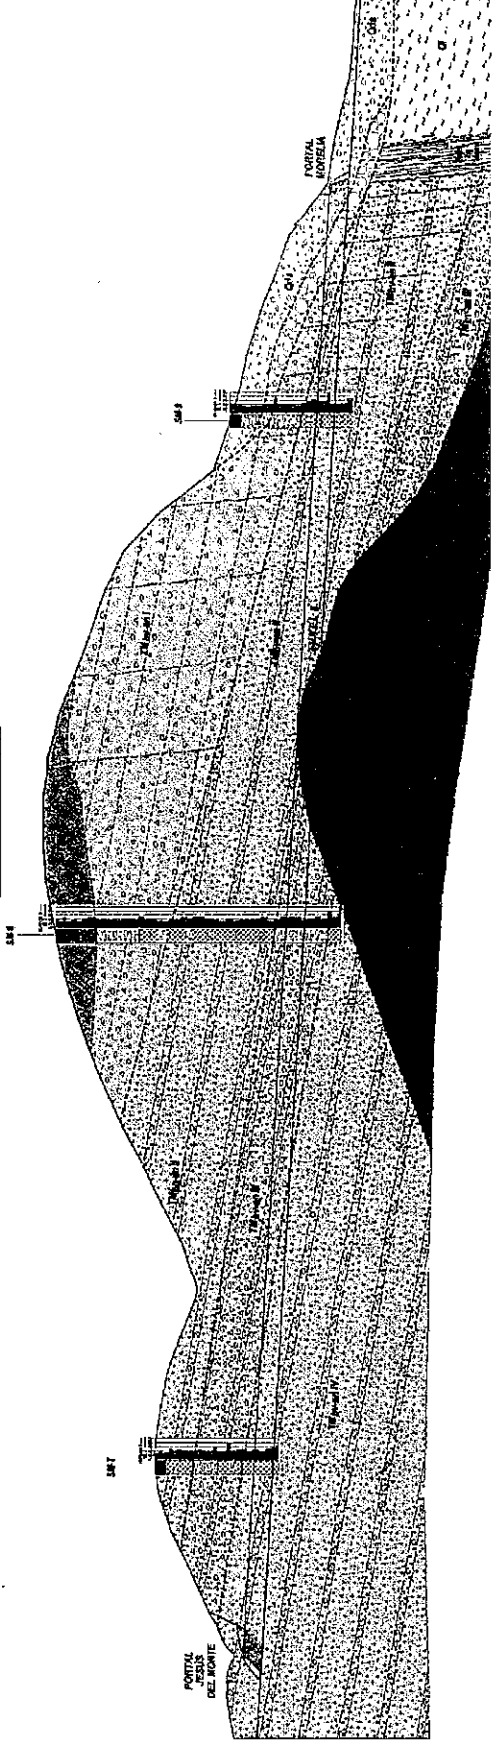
Planta y sección geológica Túnel II (ver plano 5.3)
